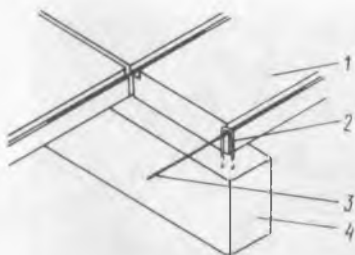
Крепление ячеисто-бетонных элементов к железобетонным конструкциям
